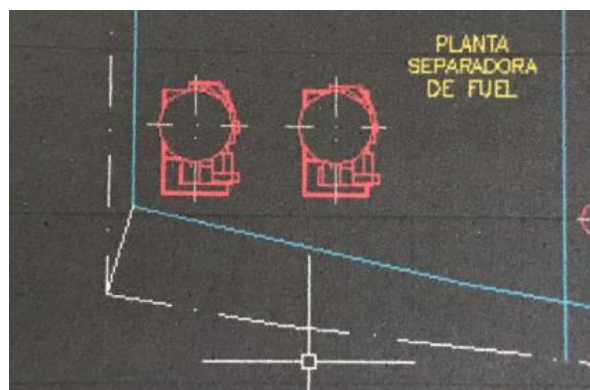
Disposición a bordo de la planta separadora de fuel
